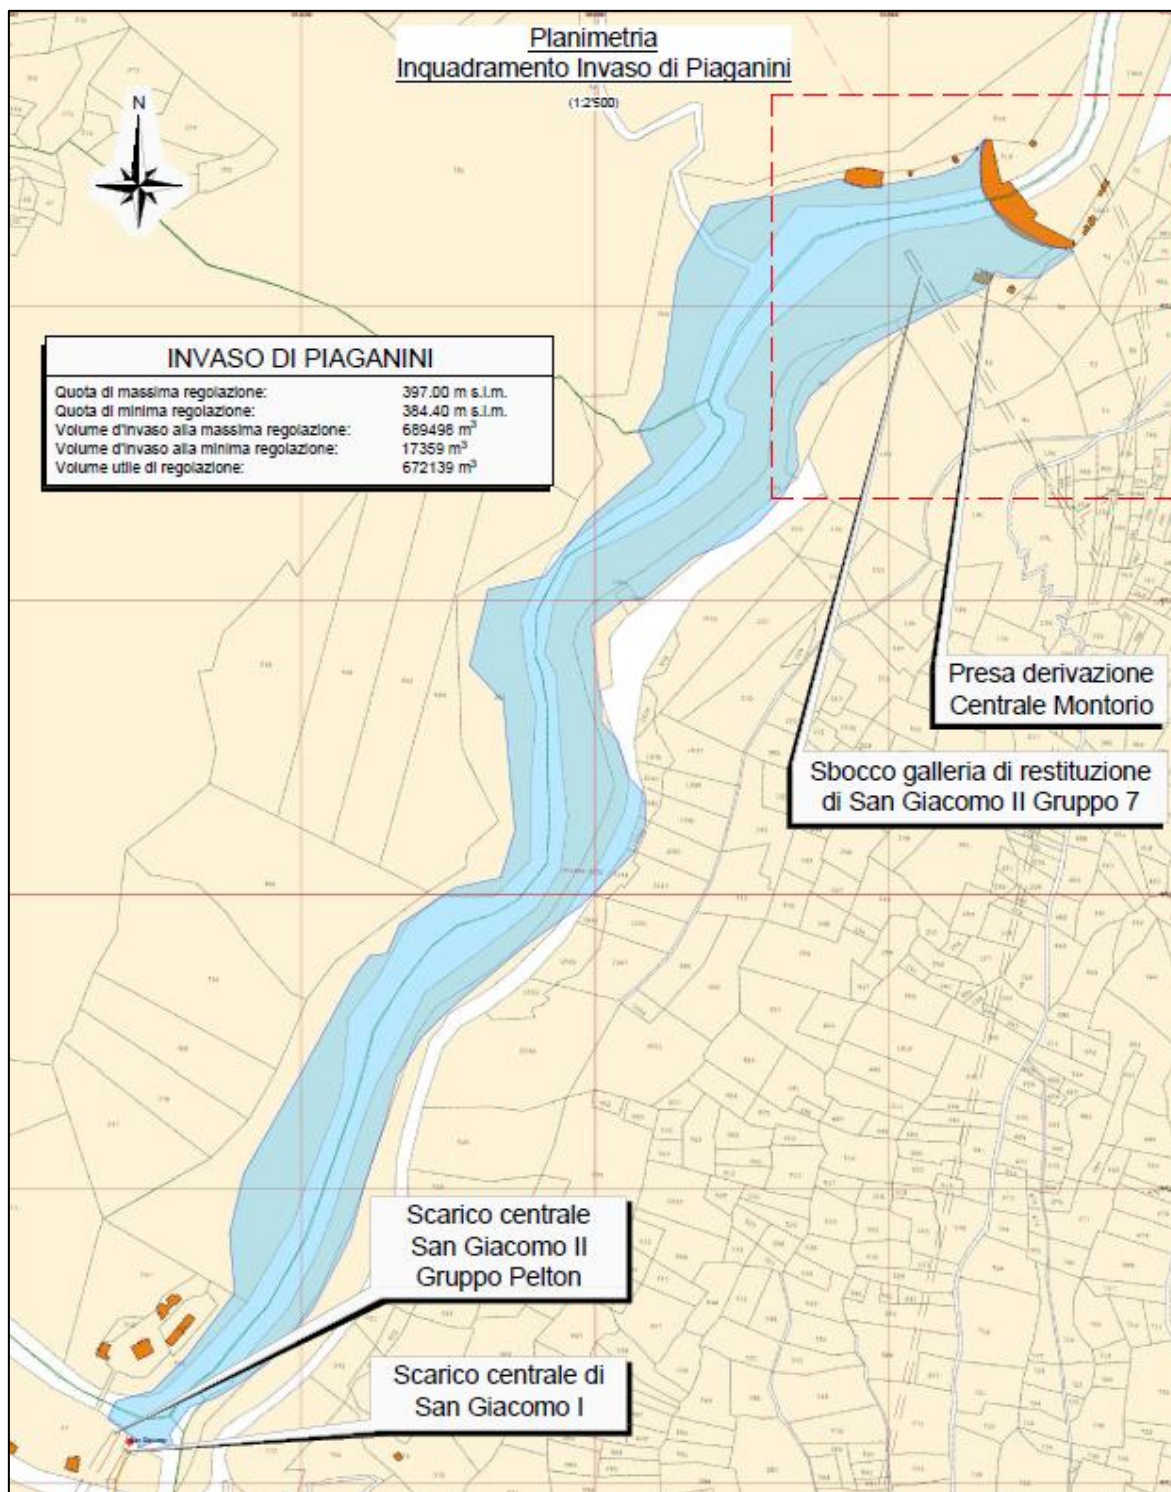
Planimetria di inquadramento zona Invaso di Piaganini
